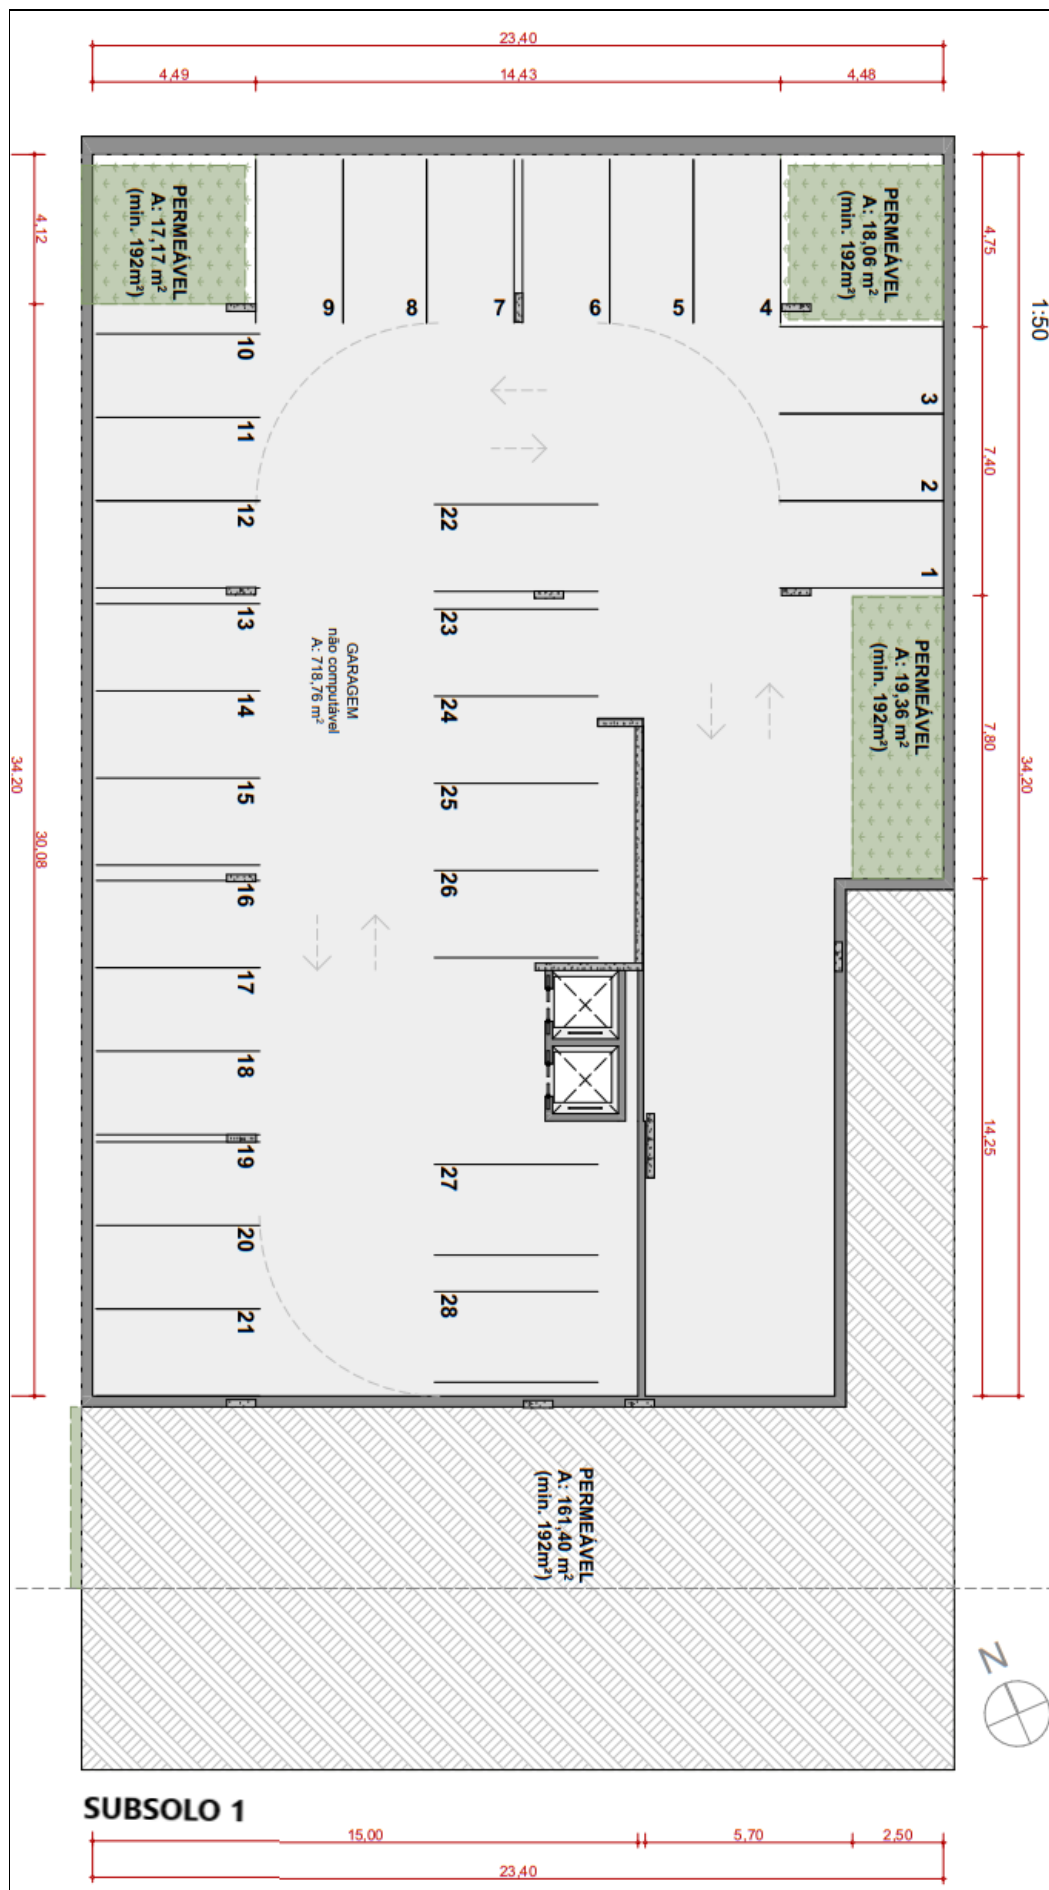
Planta do Subsolo do Condomínio Sintropia Sky Garden.
